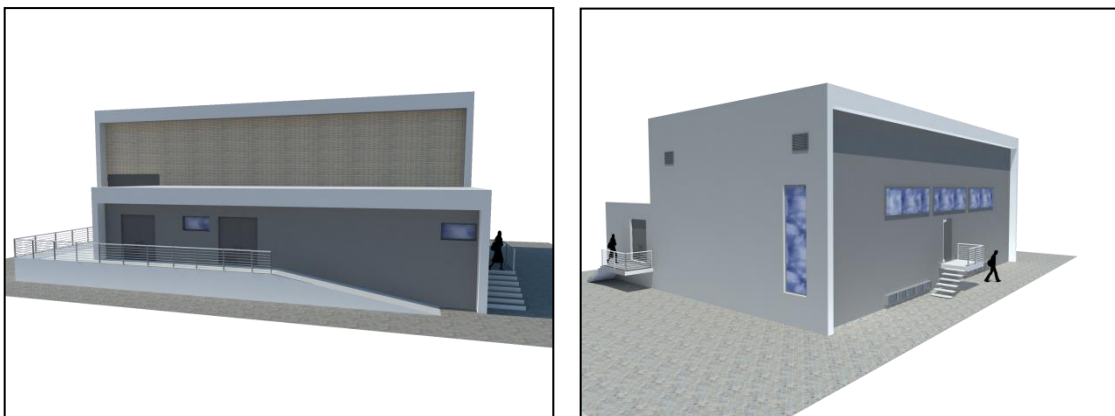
Aspetto Final após conclusão do Posto Seccionamento (Autoria: Arq.^a Mariana Neto)
